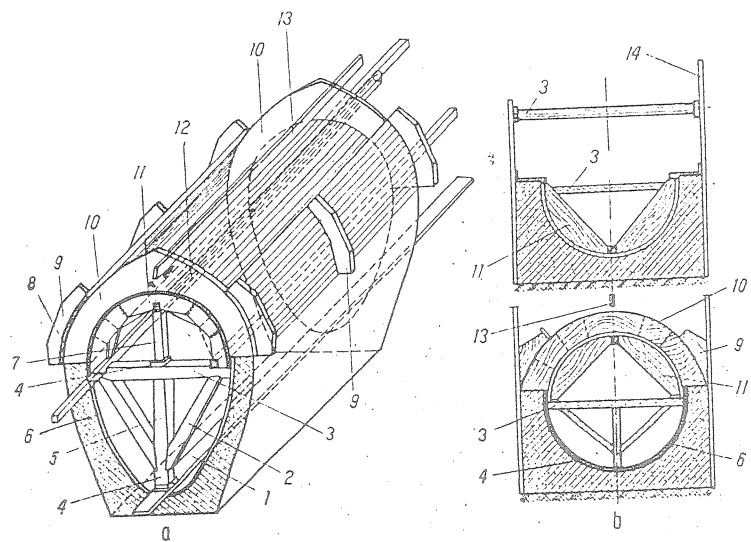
Cofraje pentru executarea canalelor monolite:
